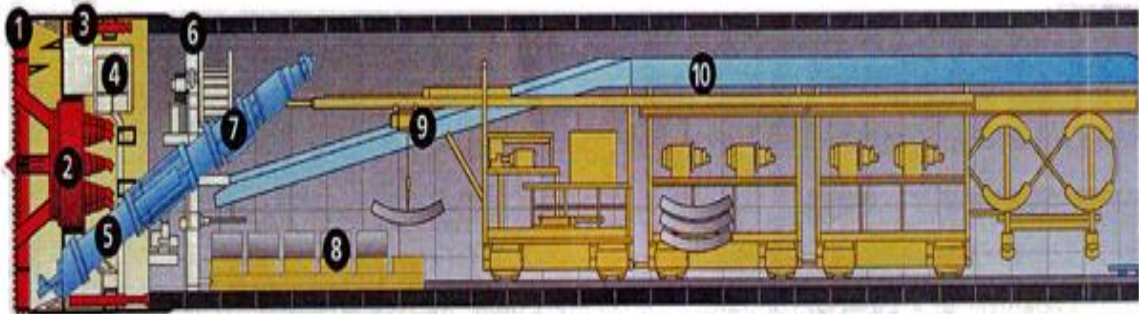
ТПМК с ґрунтовим привантаженням забою
